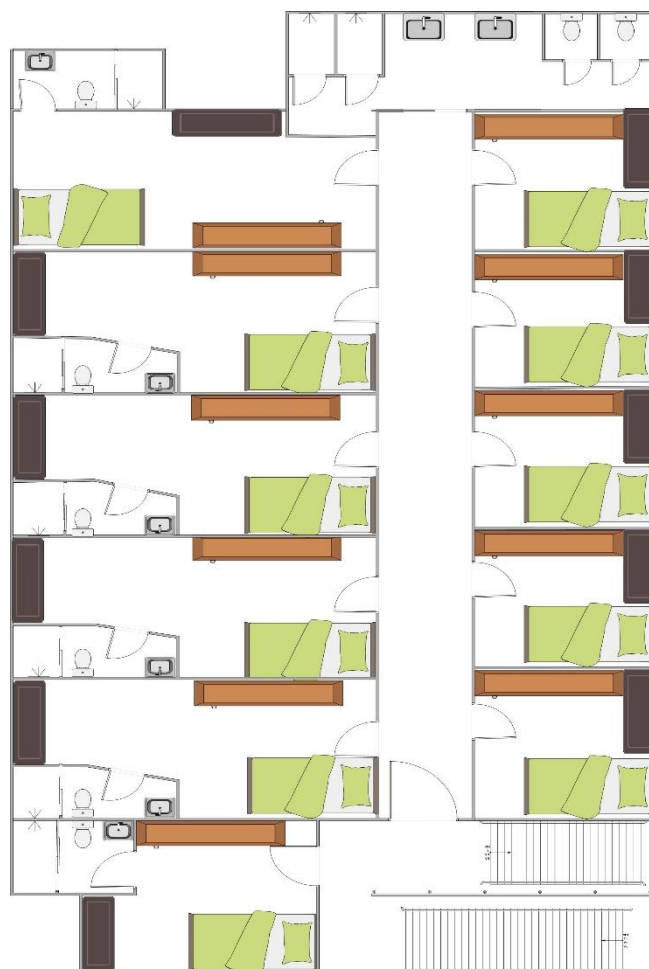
PLANTA DO SEGUNDO ANDAR DO BLOCO I
